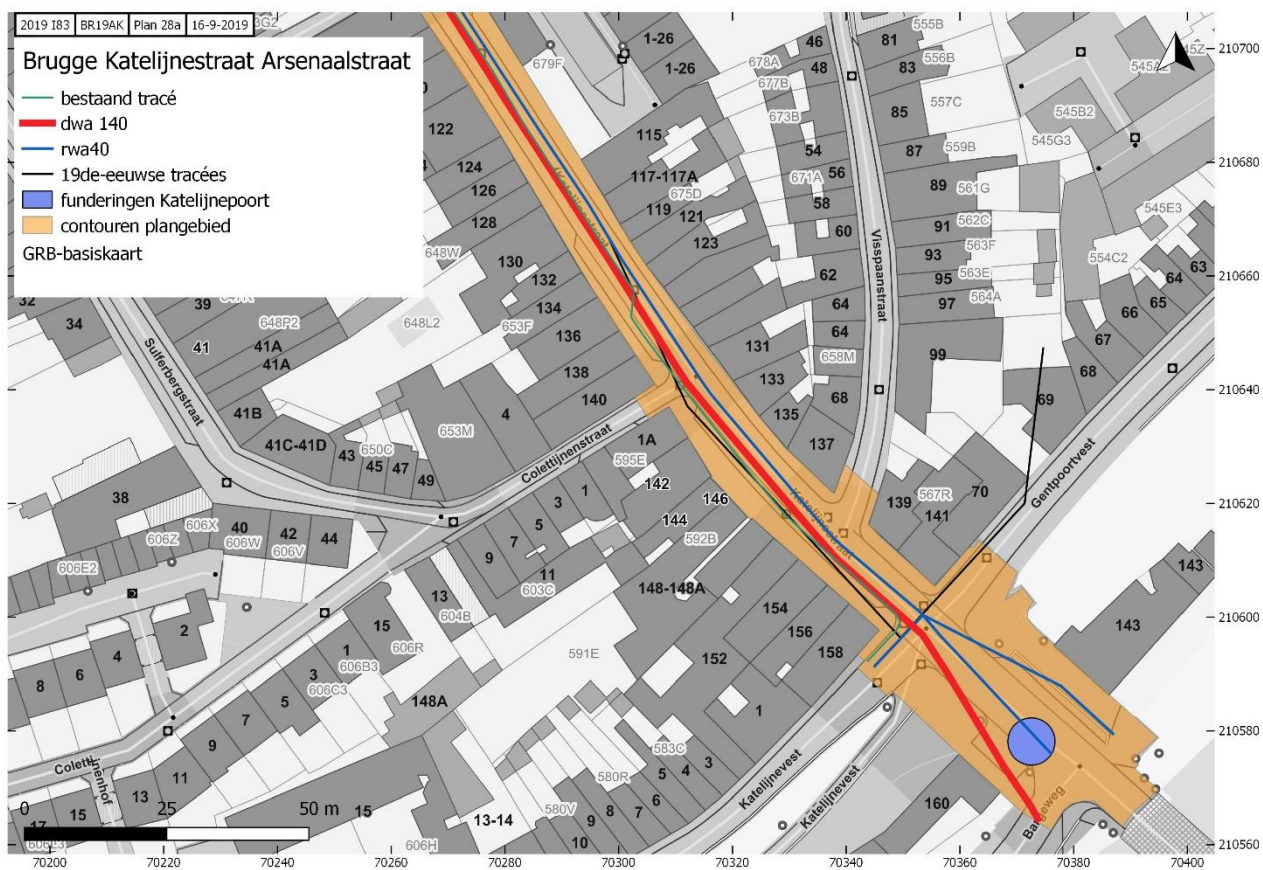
/Plan 2: het plangebied (oranje polygoon) op het GRB
